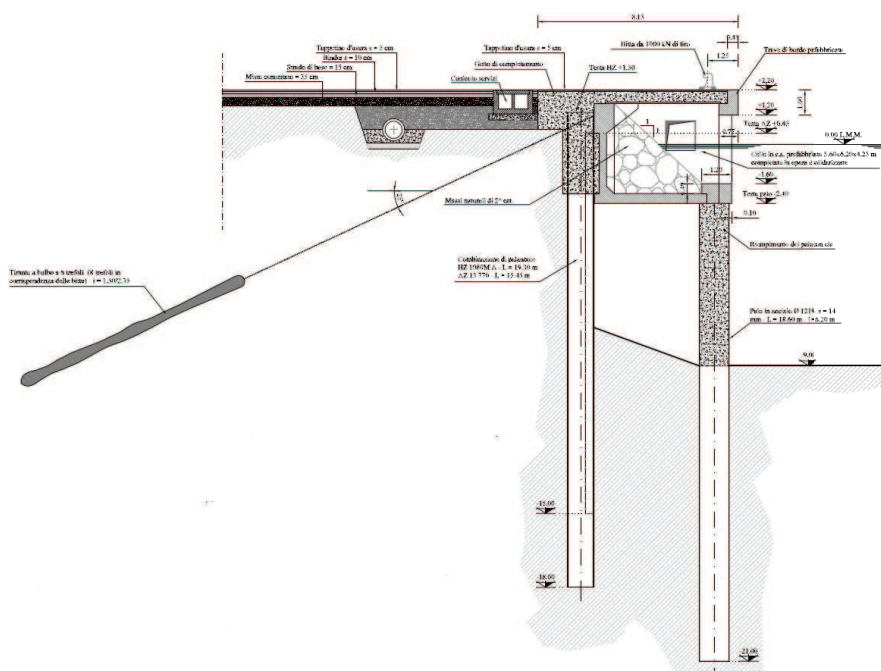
Sezione tipologia banchine di riva (PROGETTO SIGENCO).
